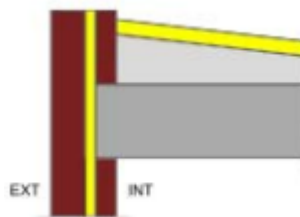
Puente térmico lineal de la fachada con la cubierta.
